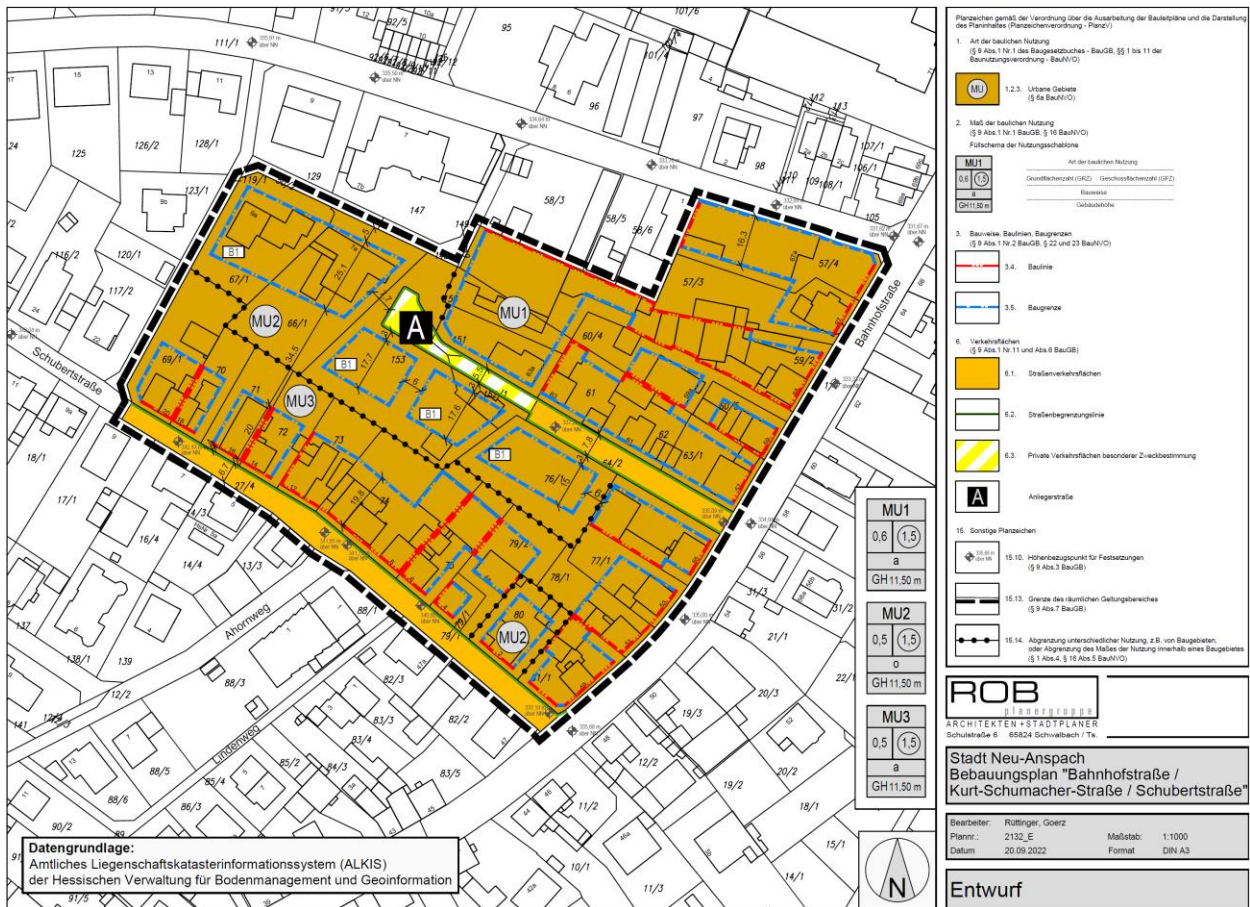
Planzeichnung des Bebauungsplans, Entwurfstand 20.09.2022
